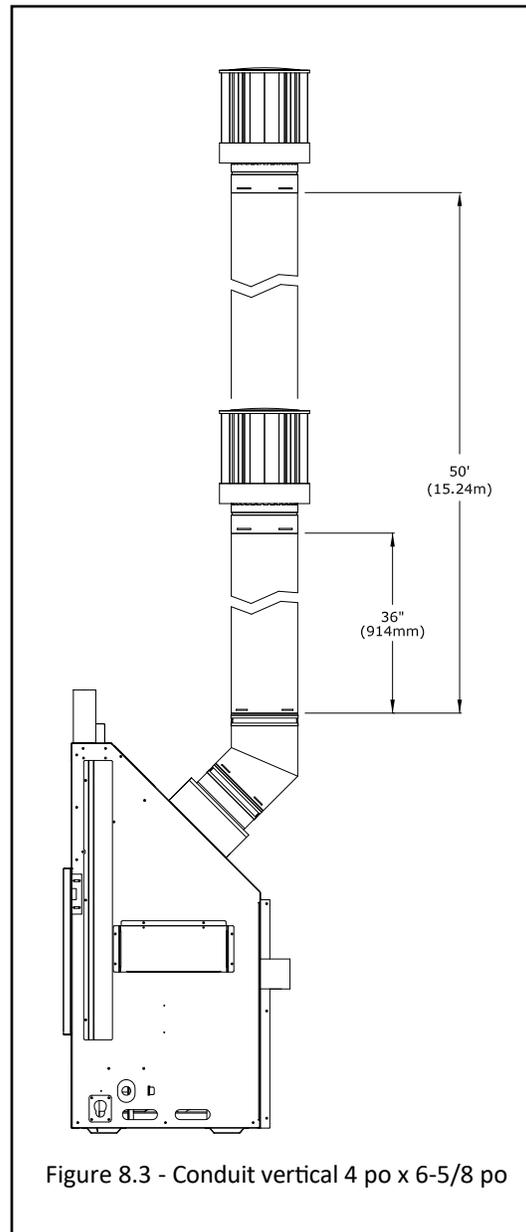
Conduit vertical 4 po x 6-5/8 po
